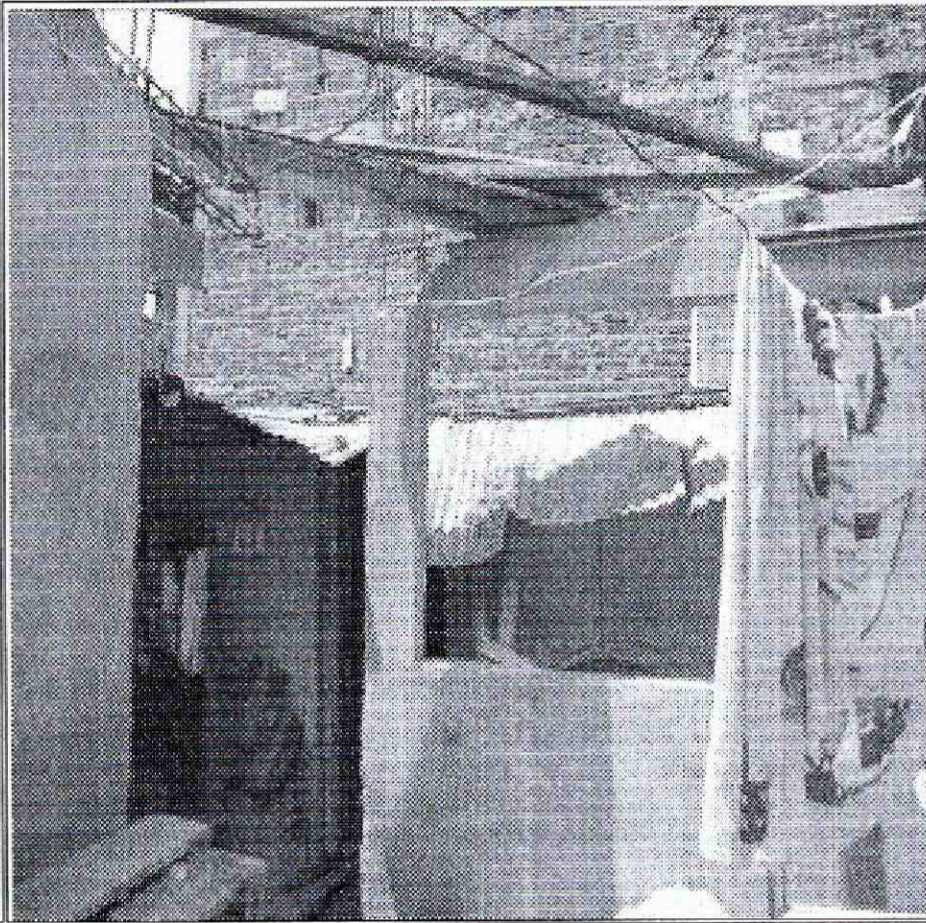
Vivienda Pre Fabricada Costado oriental predio Diagonal 68 G Sur No. 1C – 16 Este
